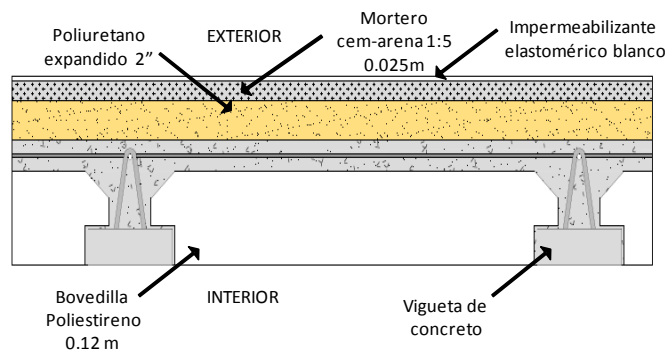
Corte esquemático del aislamiento con poliuretano esparcido de 2" en losa
